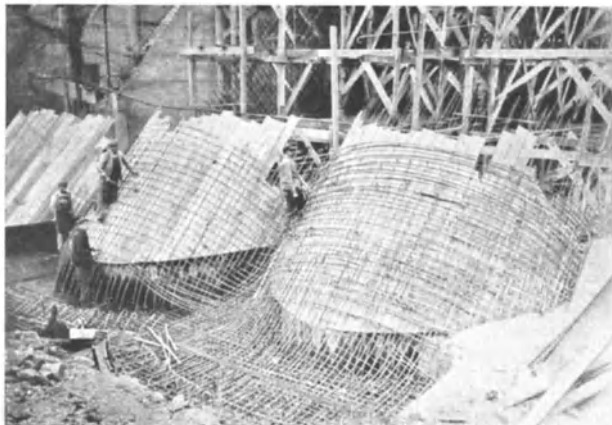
Rophemel-Staumauer. Bewehrung der Gewölbe.
